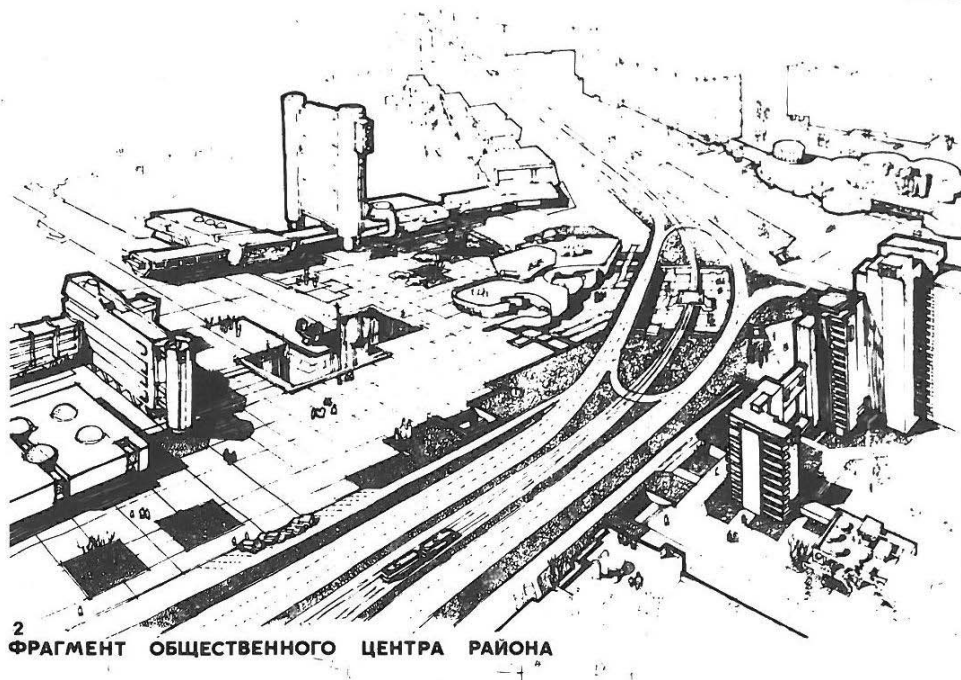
Схема планувального району «Сихів» (з архіву Аліни Петрової)
